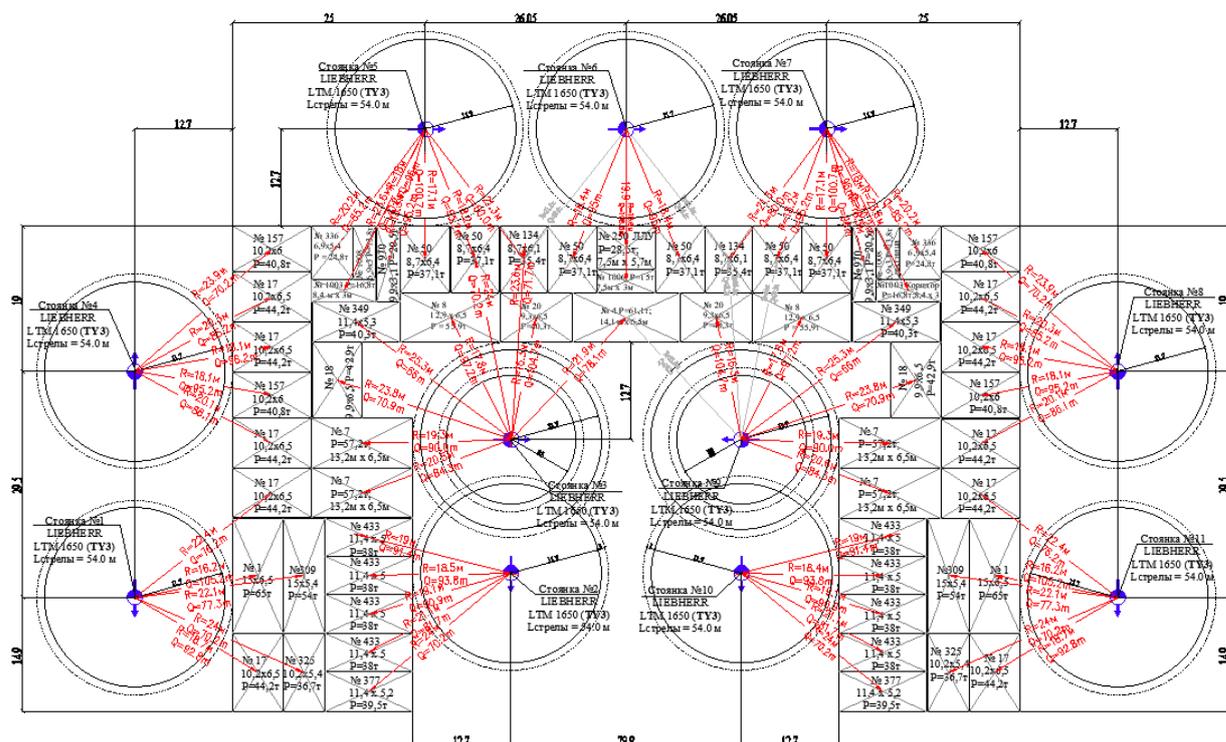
Схема имитационного моделирования механизации монтажных работ мобильным краном на спецшасси для трехсекционного П-образного жилого здания «Тип 4». План
